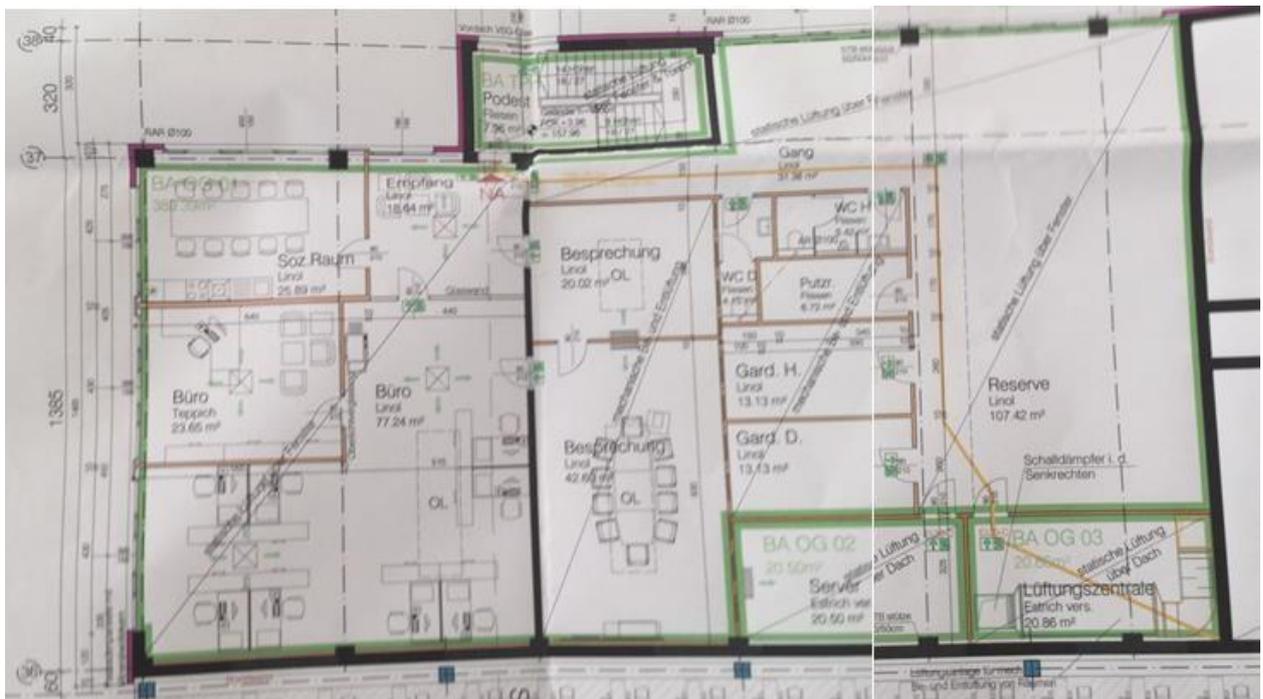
; Büro- / Betriebsgebäude Obergeschoß (anschließende Flächen im Osten Luftraum)
